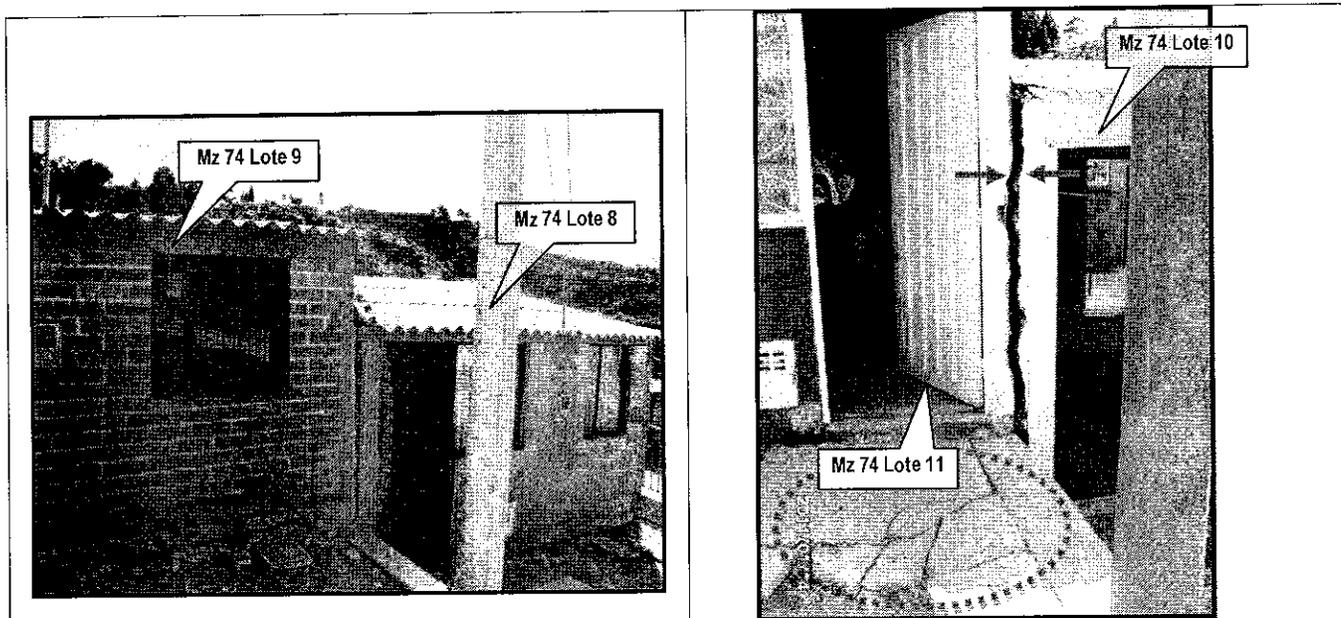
y 3. Vista del predio de la 5D Este No 62 – 09 sur, localizado ladera debajo de la Urbanización Germinar I, frente al muro de contención en gaviones, en la cual se evidencian que grietas en pisos y muros que atraviesan los mismos, con aberturas de hasta 7cm Diciembre 14 de 2011.
